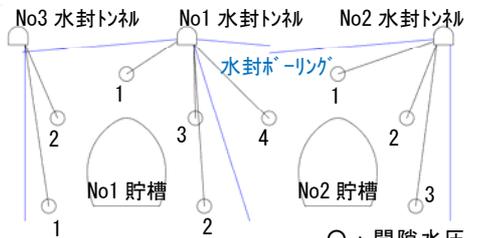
貯槽周辺間隙水圧配置(全 10 断面)
